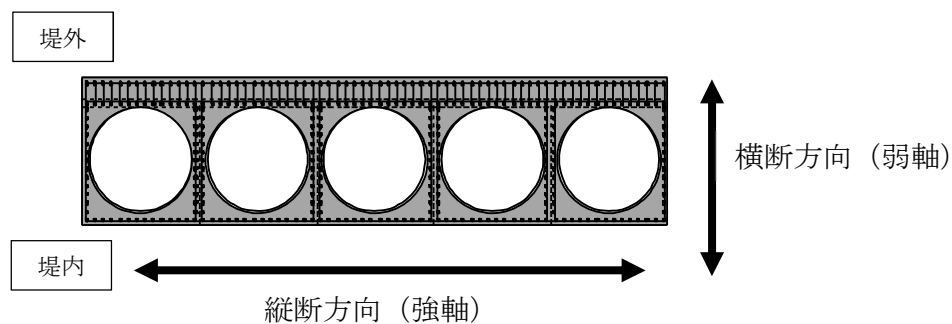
鋼管杭鉄筋コンクリート防潮壁断面図
